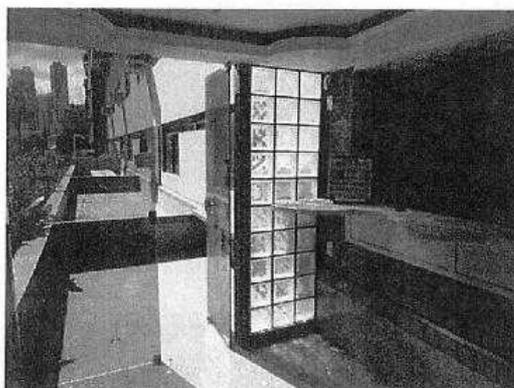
Mostra que o acréscimo neste Apto possui uma área coberta e outra descoberta (vista para oeste).
